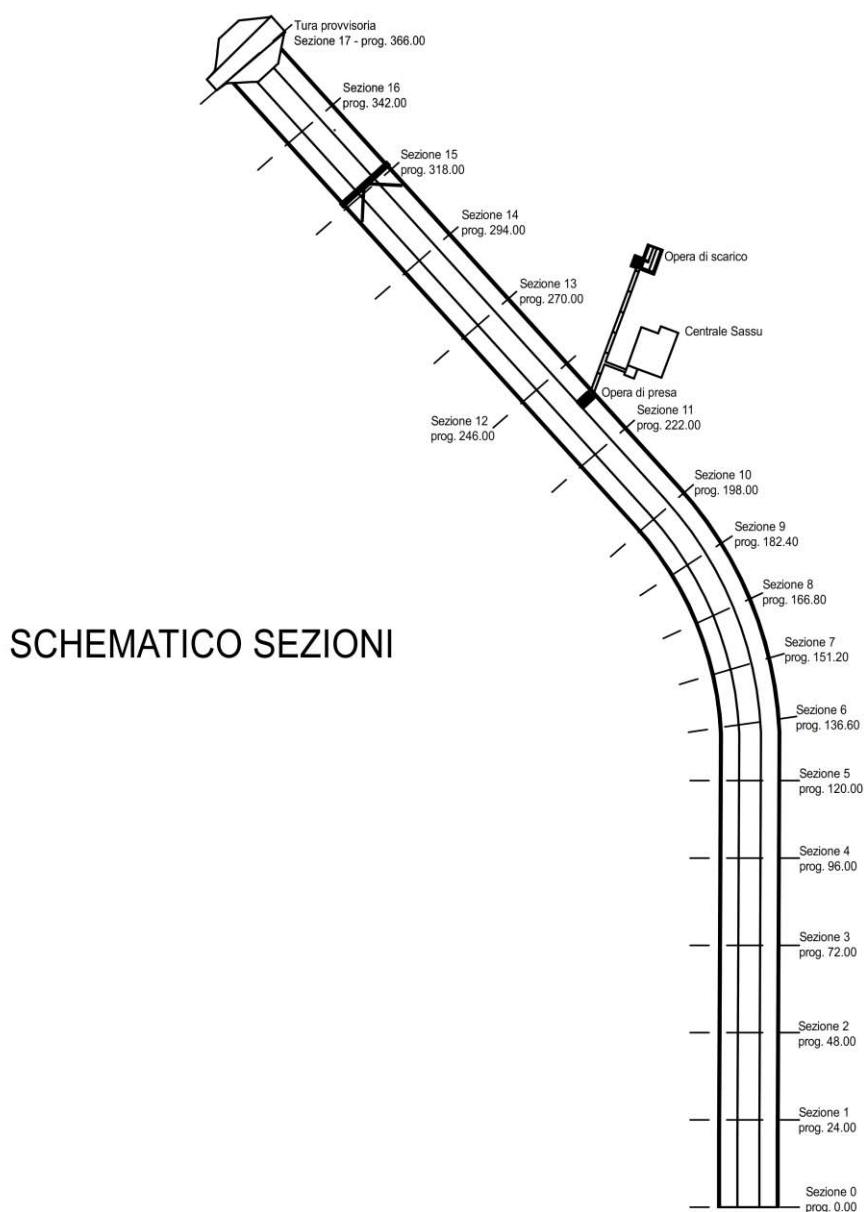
Planimetria con Sezioni, corrispondenza conci e ubicazione degli interventi in progetto
